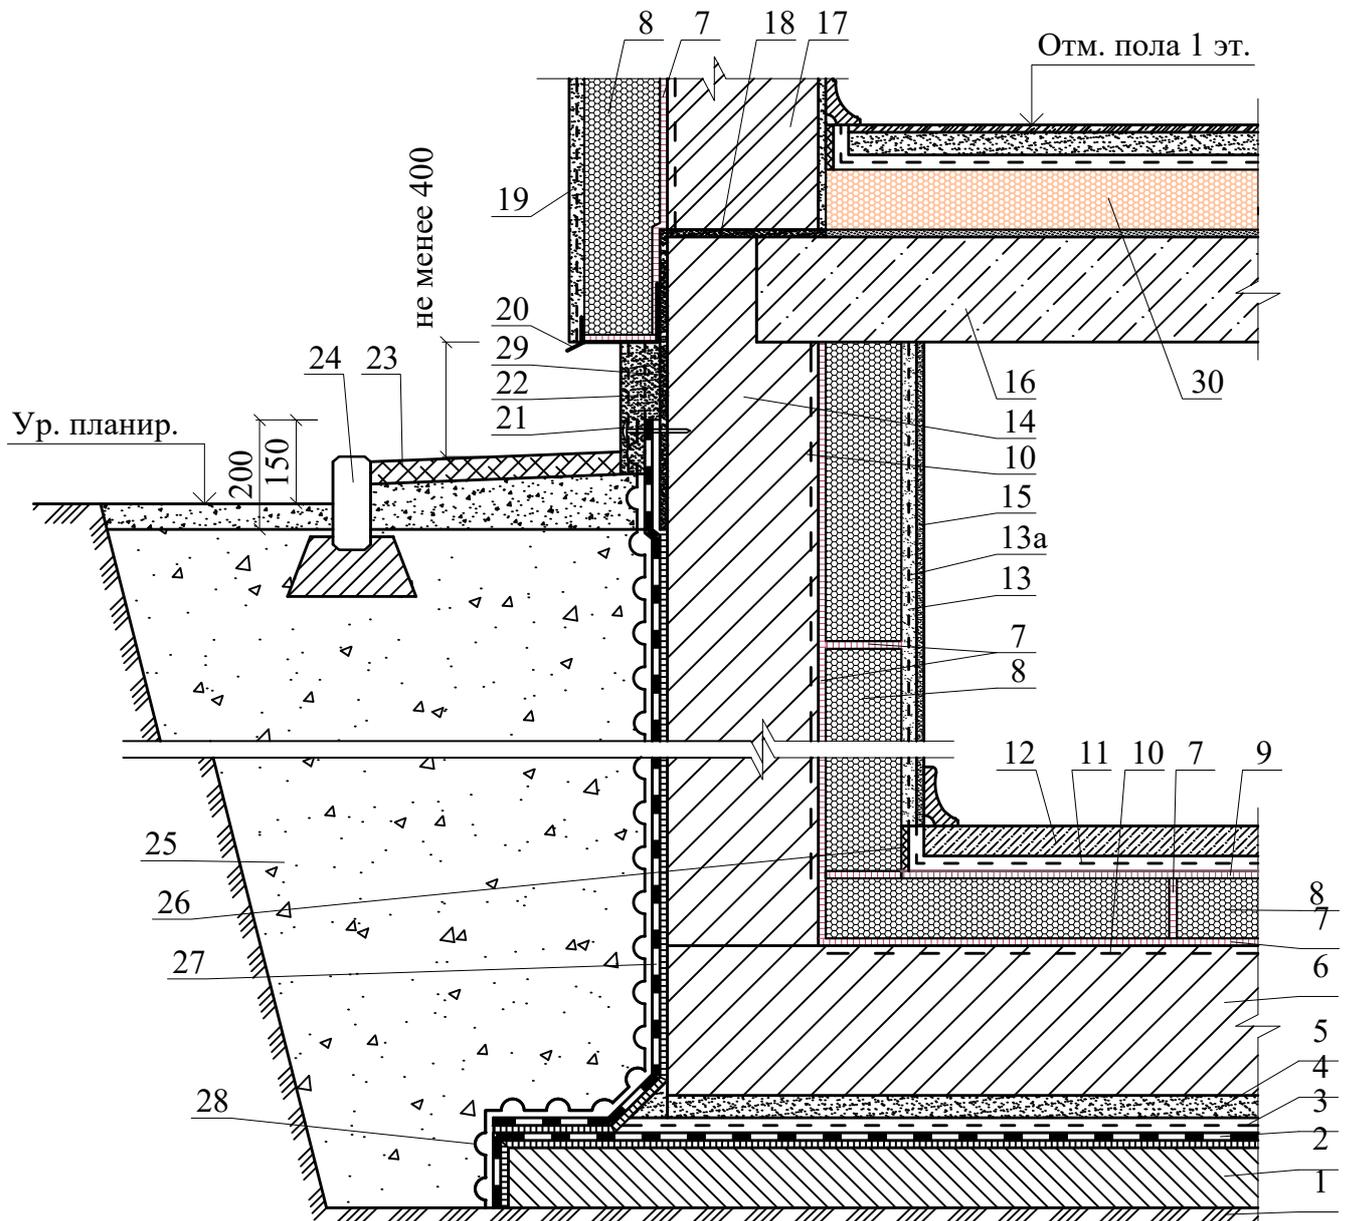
Узел В.1, В.2 к рис. 156. Изоляция стены подвала, выполненной методом "стена в стене"
